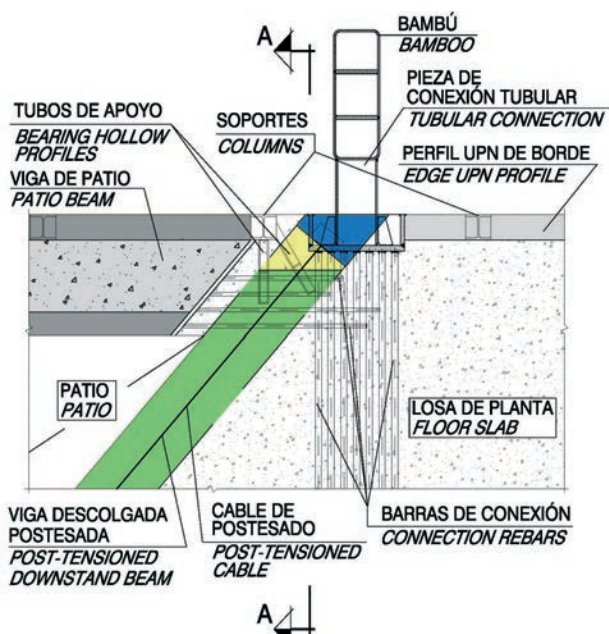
Detalle en planta del encuentro entre viga descolgada postesada, viga de patio y cajetín de recepción de un bambú
